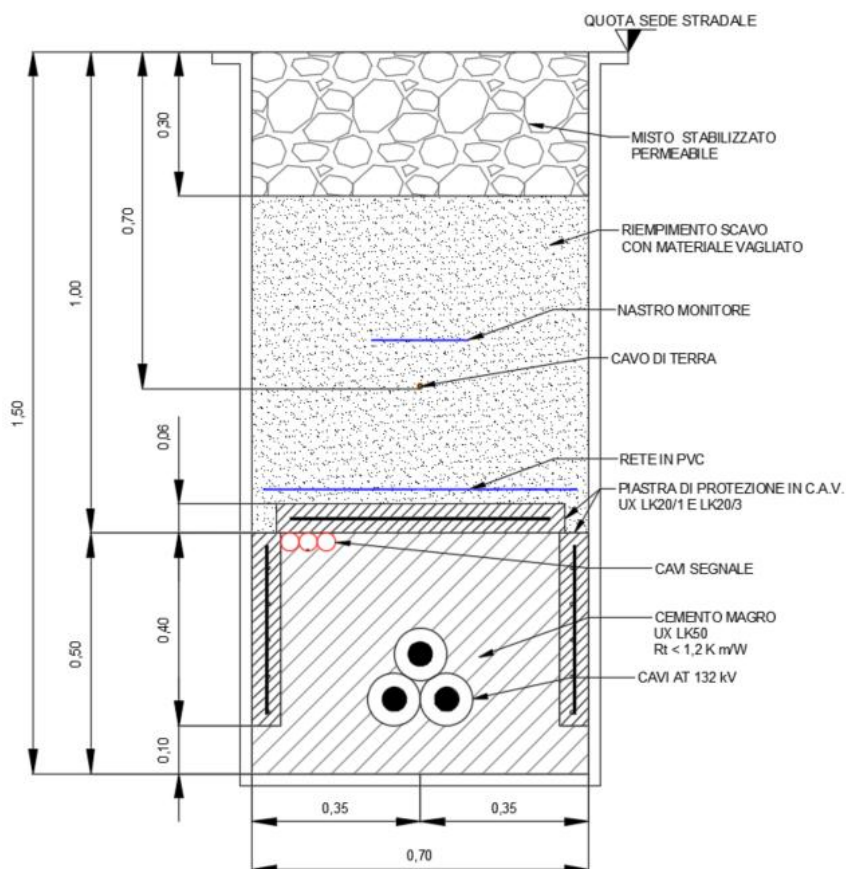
Tipico di sezione cavidotto AT su misto stabilizzato permeabile
